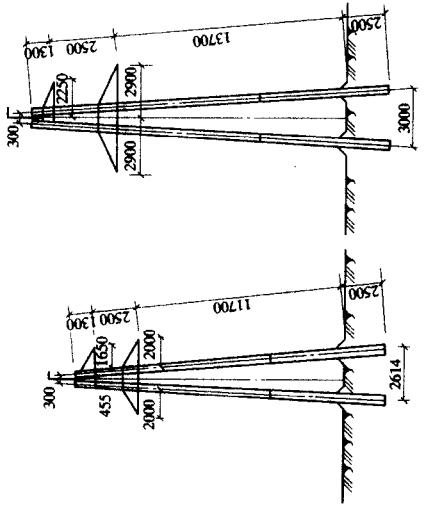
35~110kV 钢筋混凝土 A 型双杆电杆
